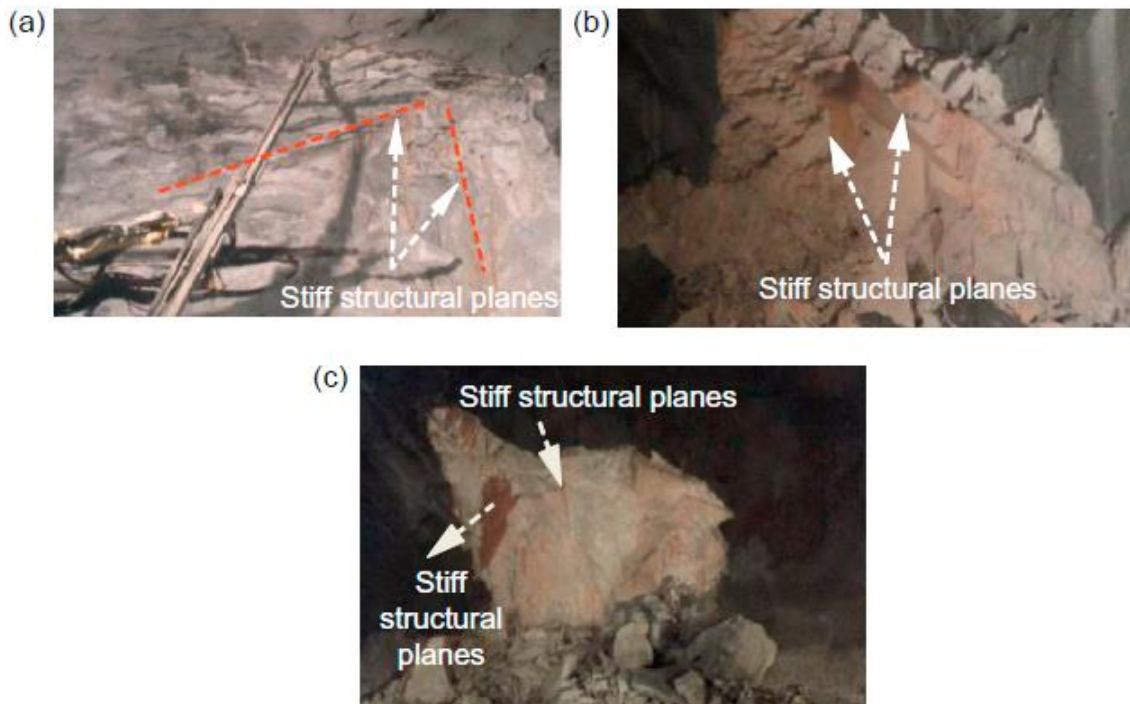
Ejemplos típicos de estallidos de roca en túneles de minería subterránea controlados por dos planos estructurales rígidos con diferente azimut o dos set de planos estructurales rígidos.
